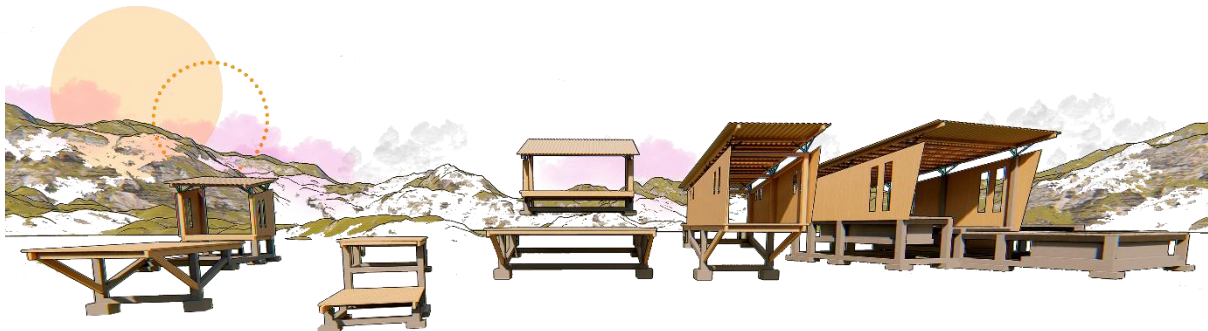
Conjunto de sistema estructural. Elaboración propia.
